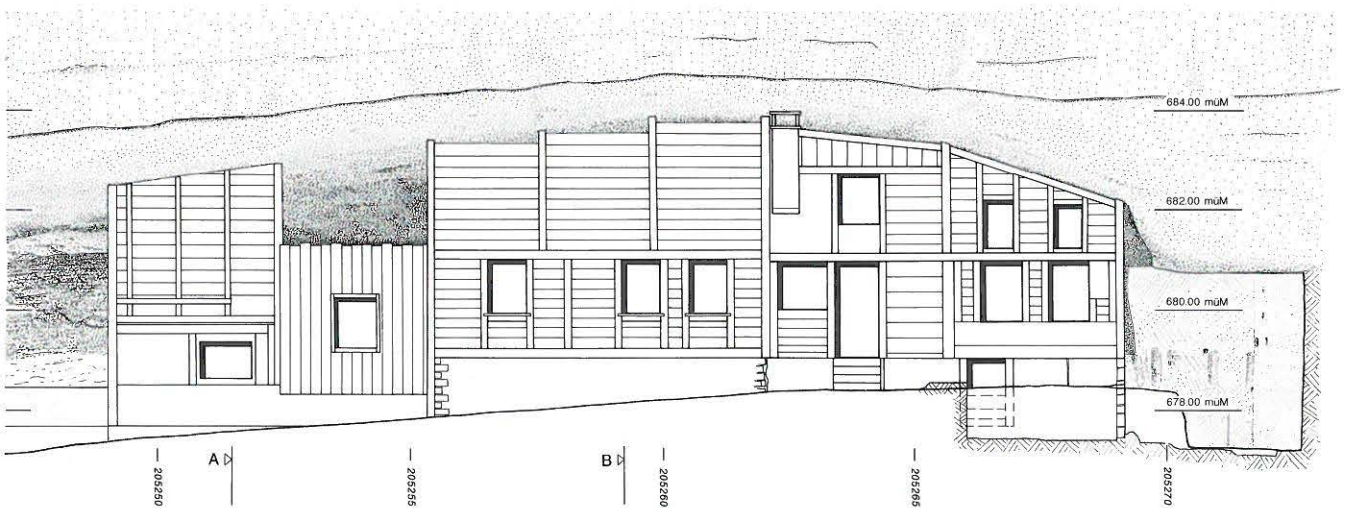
Krauchthal, Äusseres Fluhhäuschen. Vereinfachter Aufriss der Fassade. M. 1:150.
